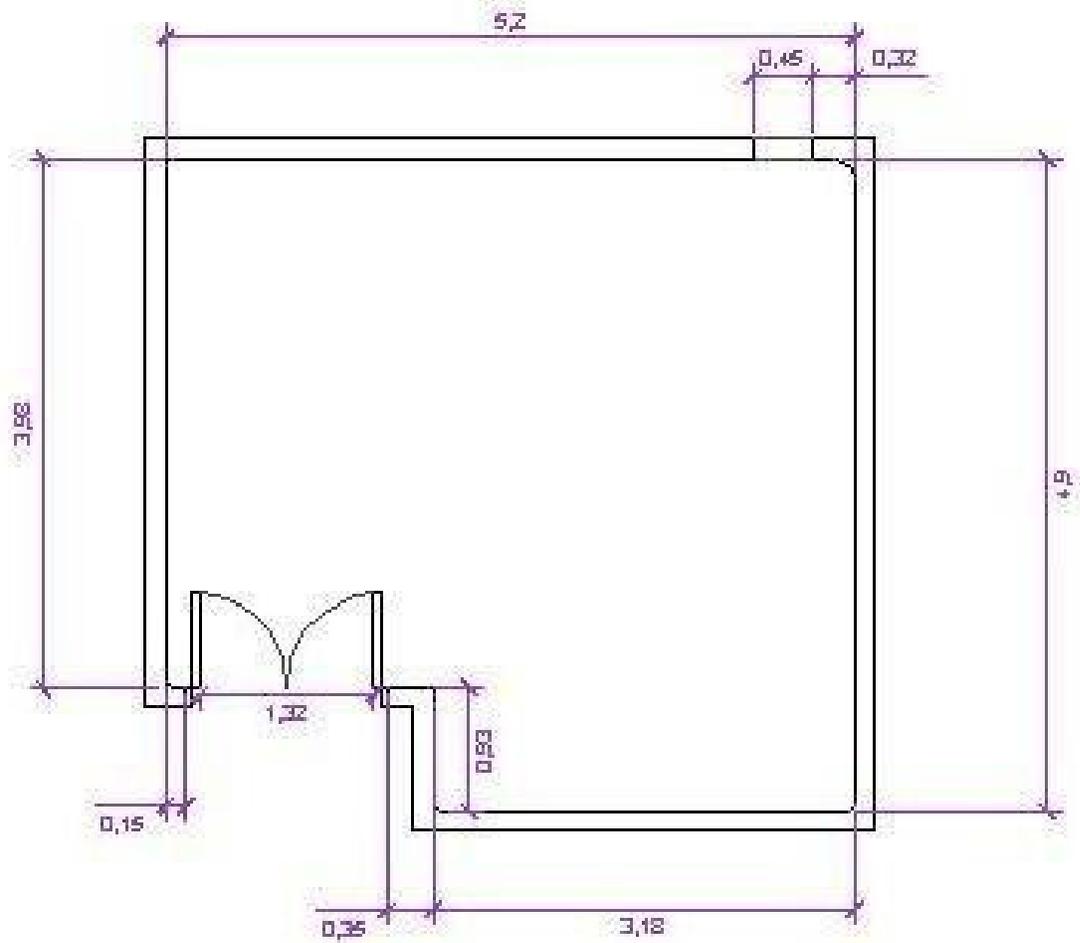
Vista de planta quirófano. (Medidas en metros).
